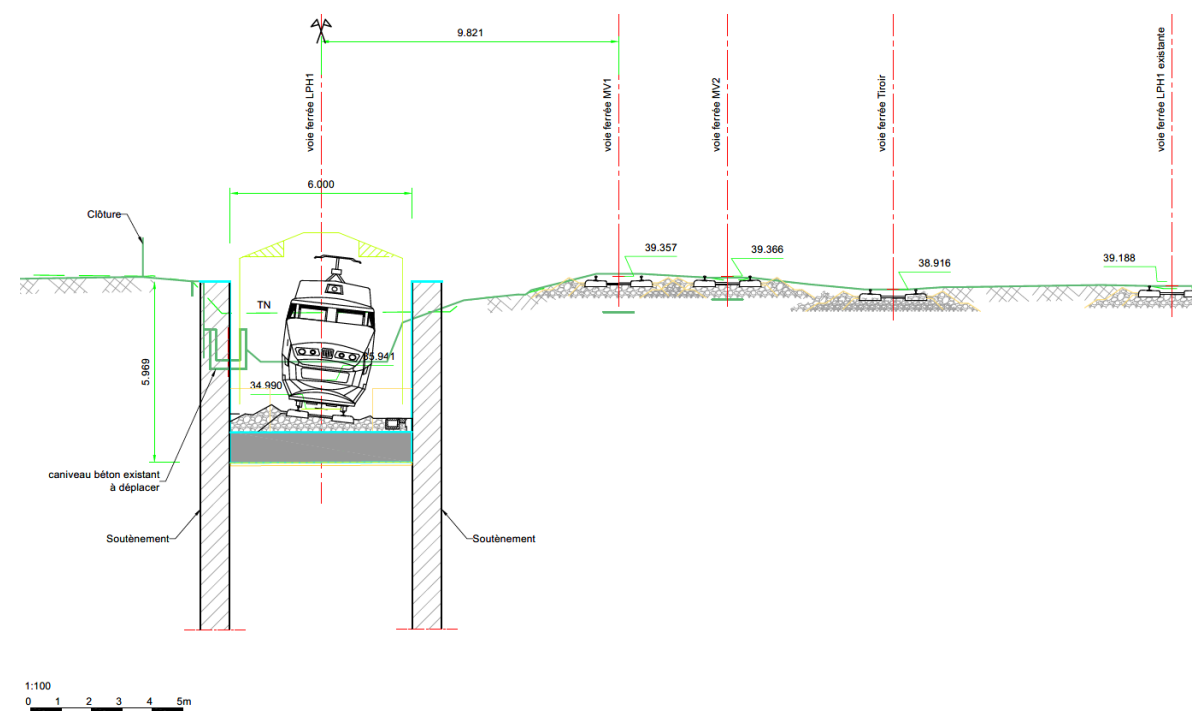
Coupe 1 - vue en coupe de la rampe d'accès ouest du terrier (source : Egis, 2021)
